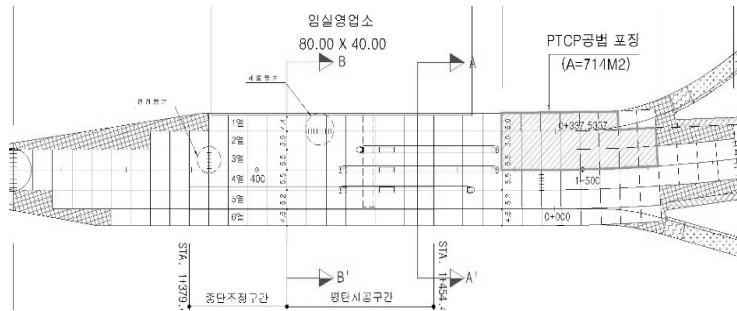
입실영업소 광장부 PTCP 시공 평면도
